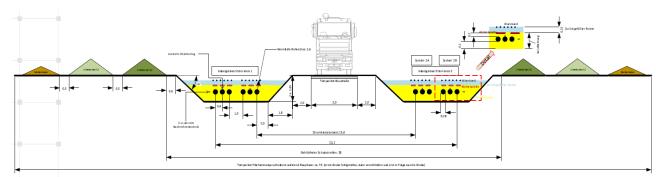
mögliches Trassenprofil – offene Bauweise
